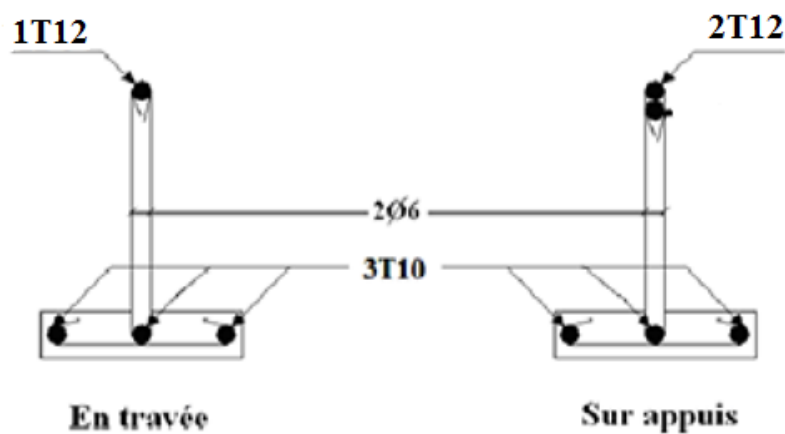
Ferrailage des poutrelles en Travée et en Appuis.
